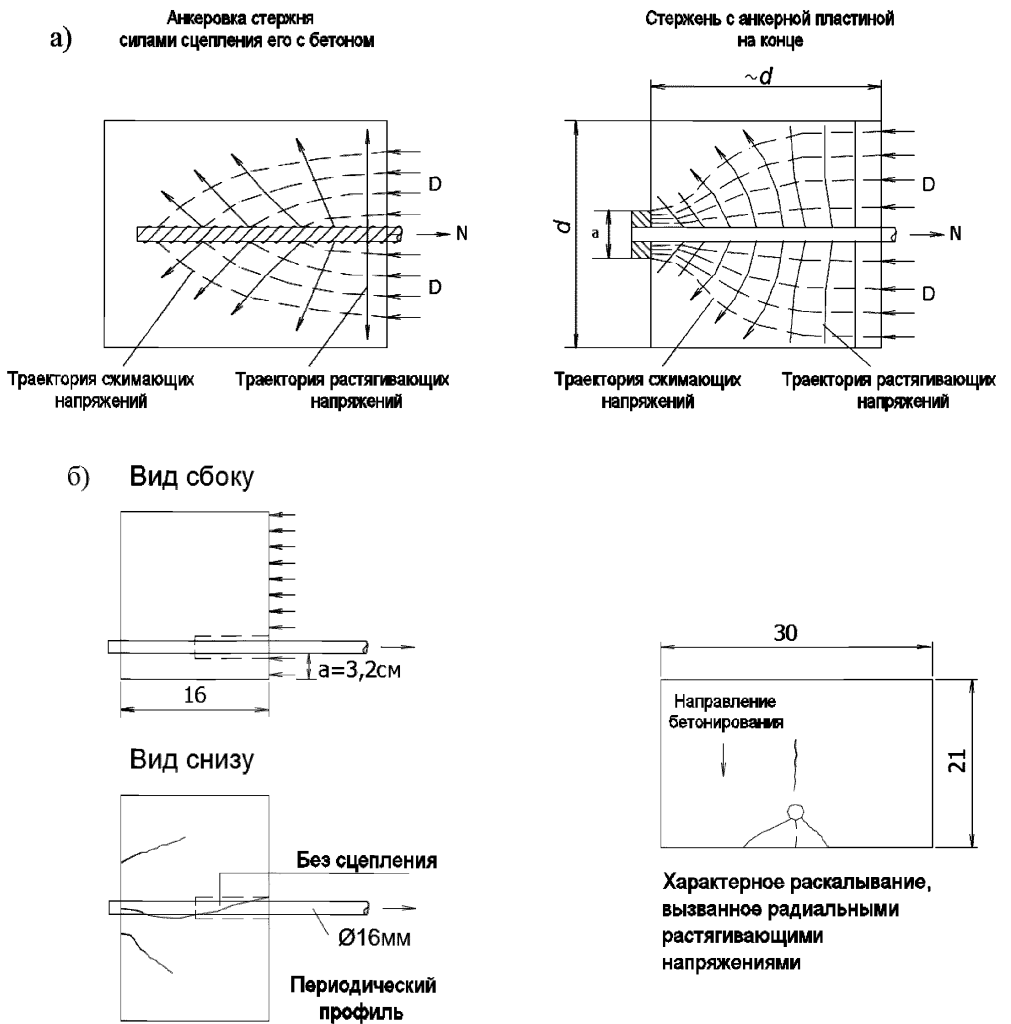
Траектории главных напряжений в зоне анкерки арматурного стержня (а) и трещины в защитном слое бетона при анкерке стержней усилиями сцепления (б)
